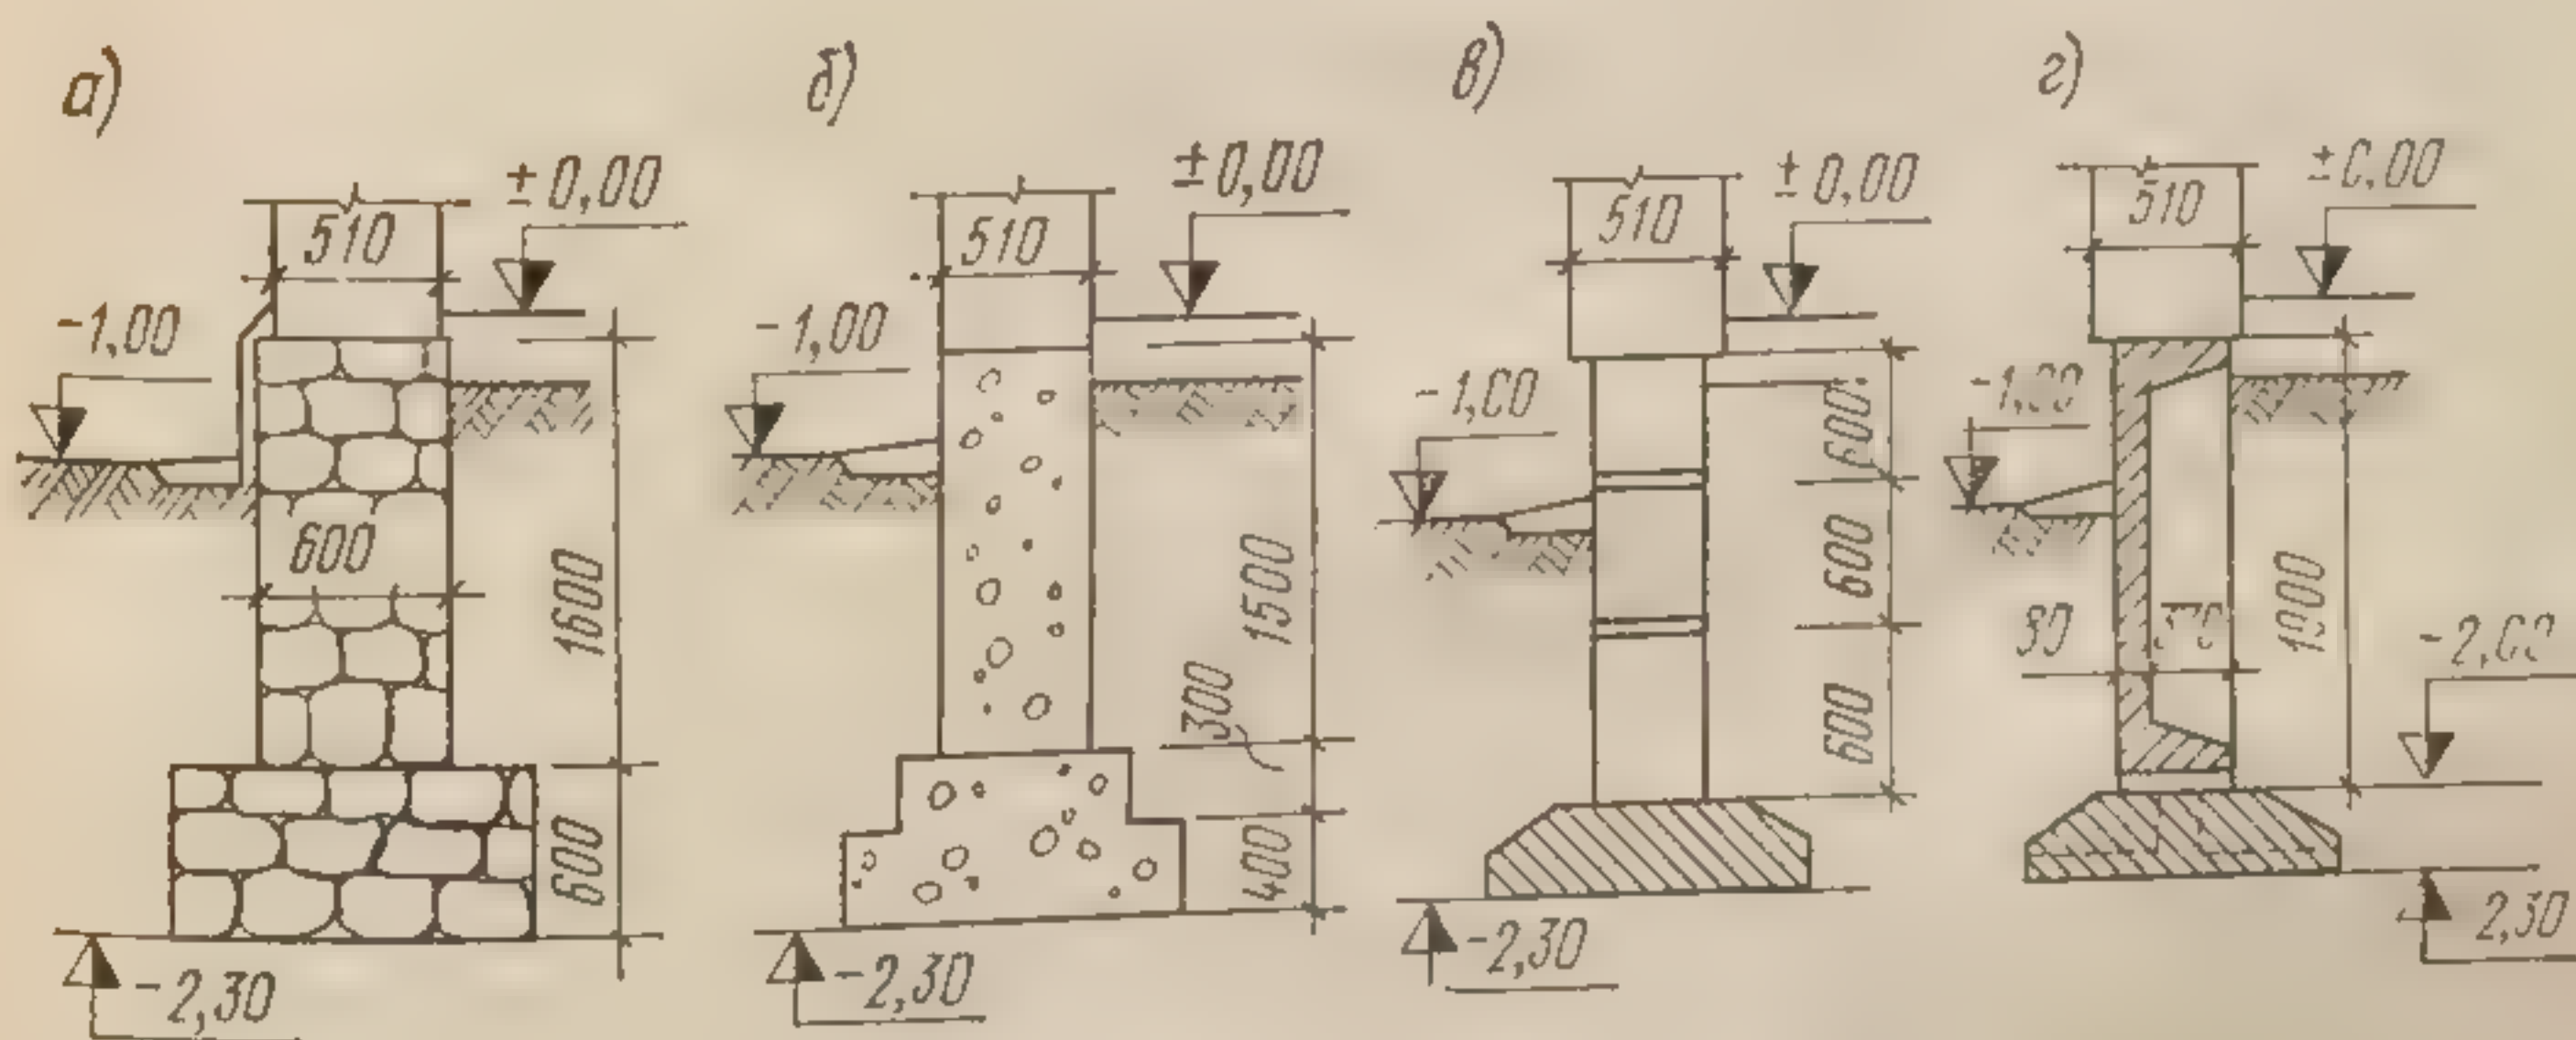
Схемы ленточных фундаментов к табл. 5:
